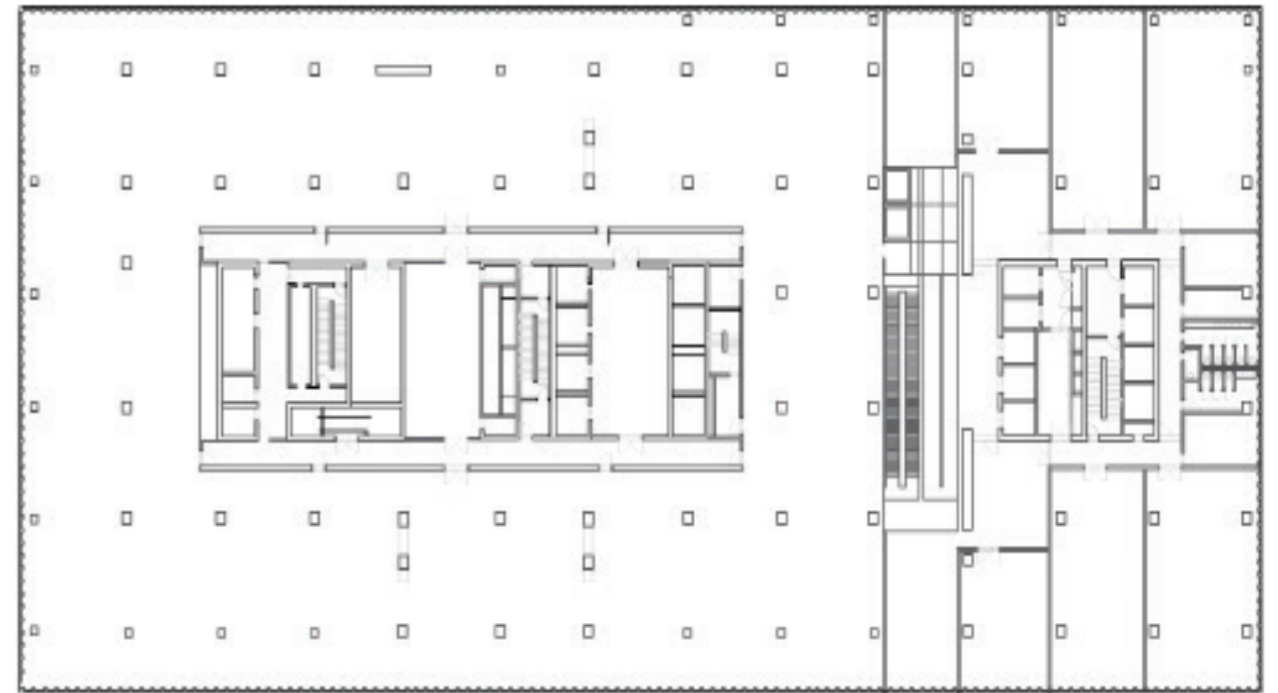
Planta 6to piso. Planta realizadas por el autor basados en los dibujos del edificio.
